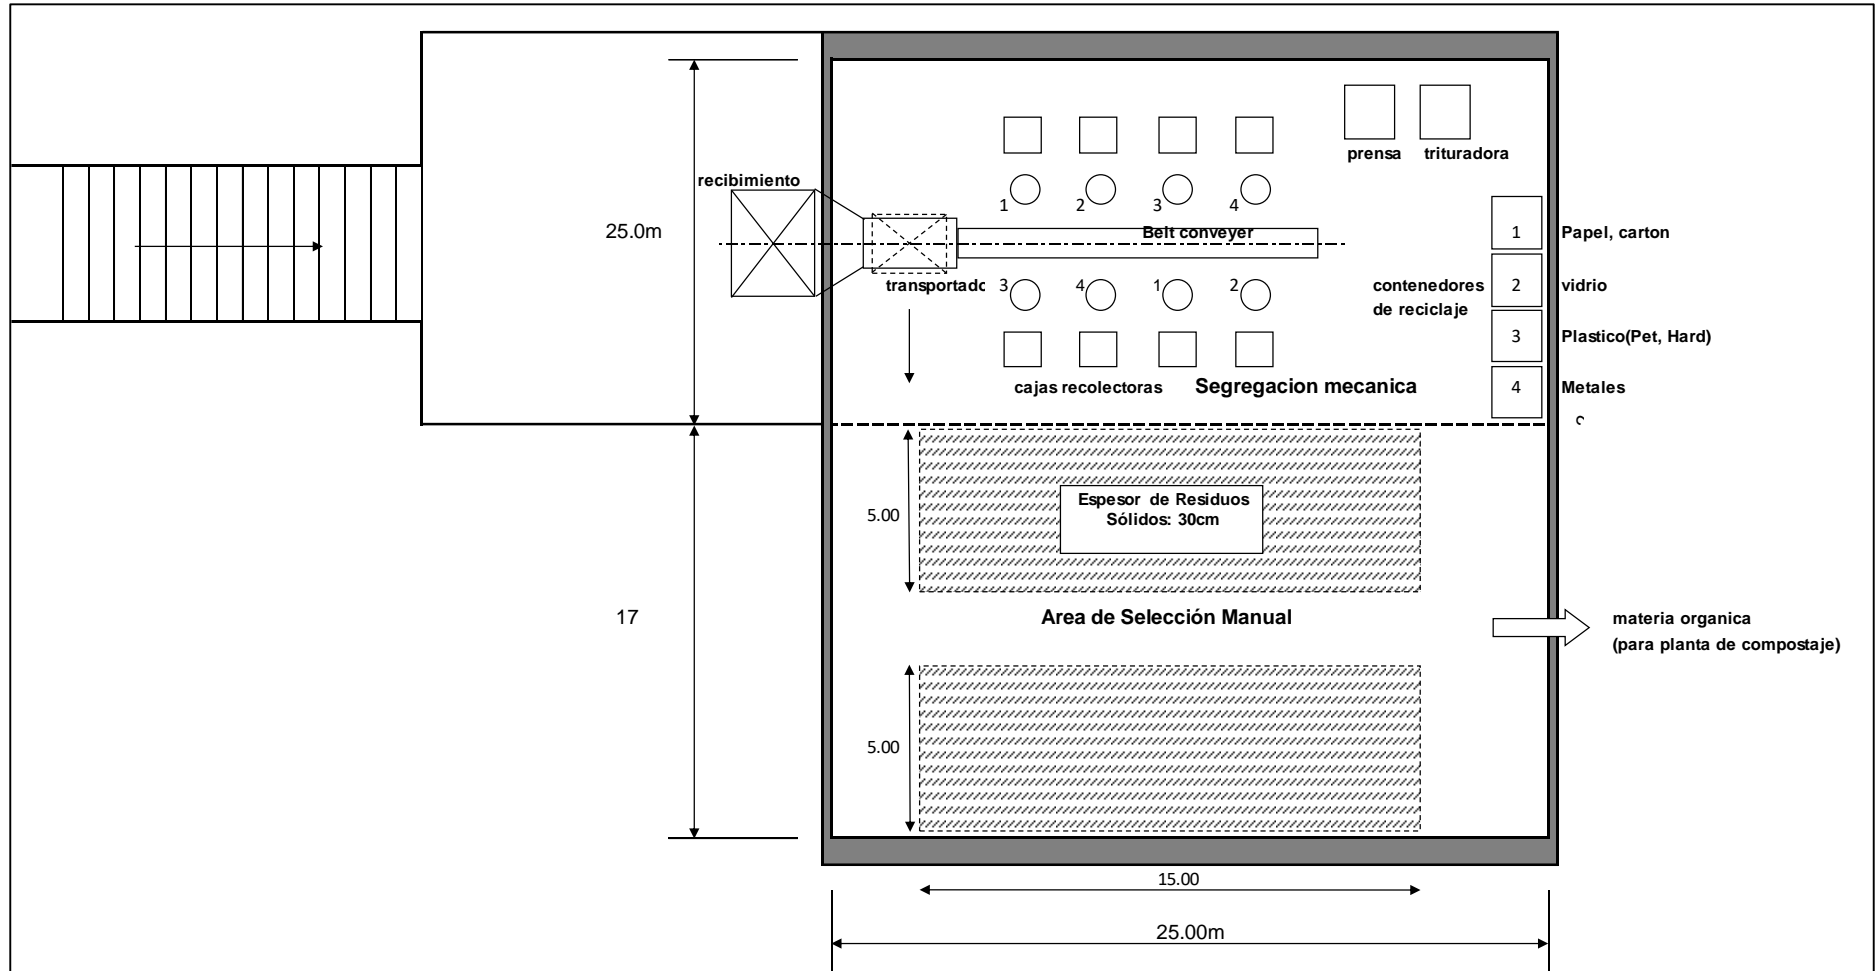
Diseño de la planta de reciclaje. Elaboración propia.
